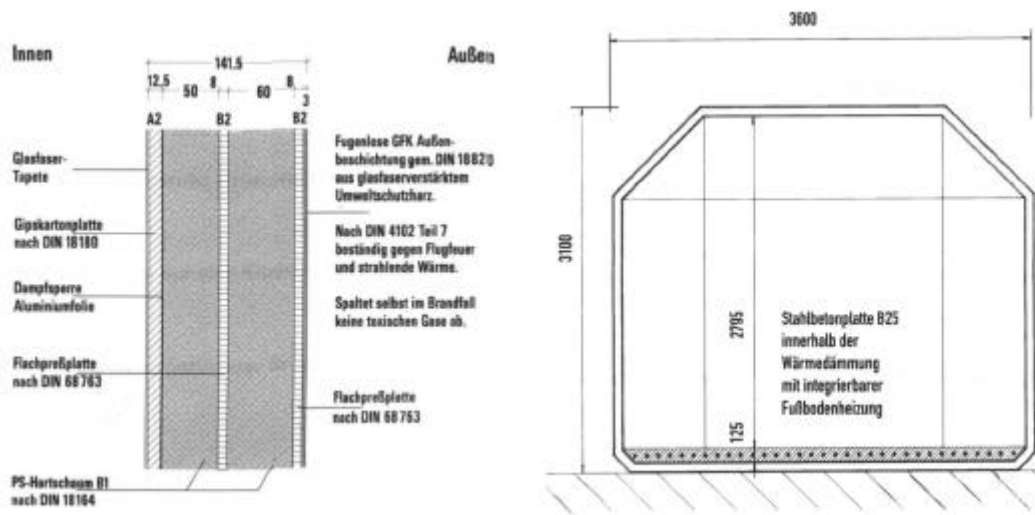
Detaildarstellung des Konstruktionsaufbaus (Typ 3600 / 3600)
